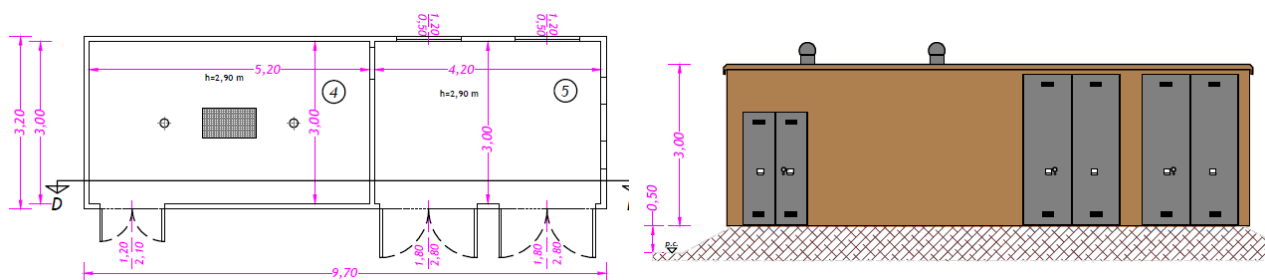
Pianta e profilo delle cabine MT/BT "1.A", "1.B" e "2.A"
